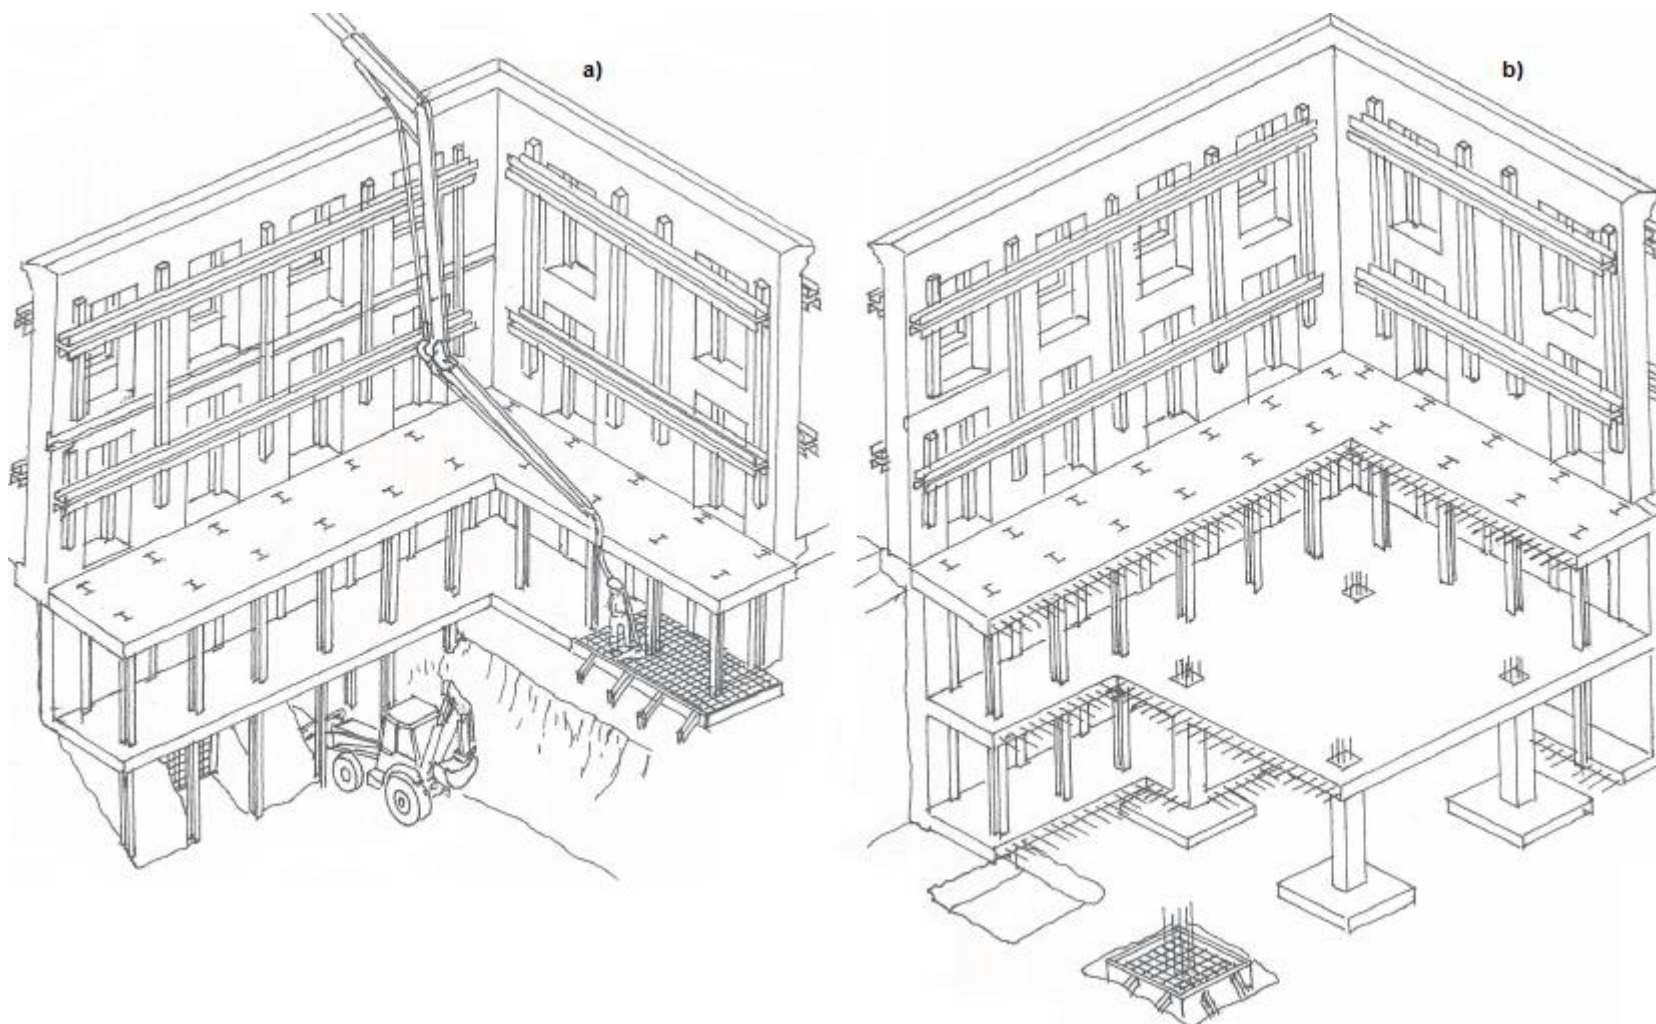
Construção da cave: a) construção do segundo nível; b) construção das fundações dos pilares, da laje de fundo, dos pilares e das restantes lajes [55]
